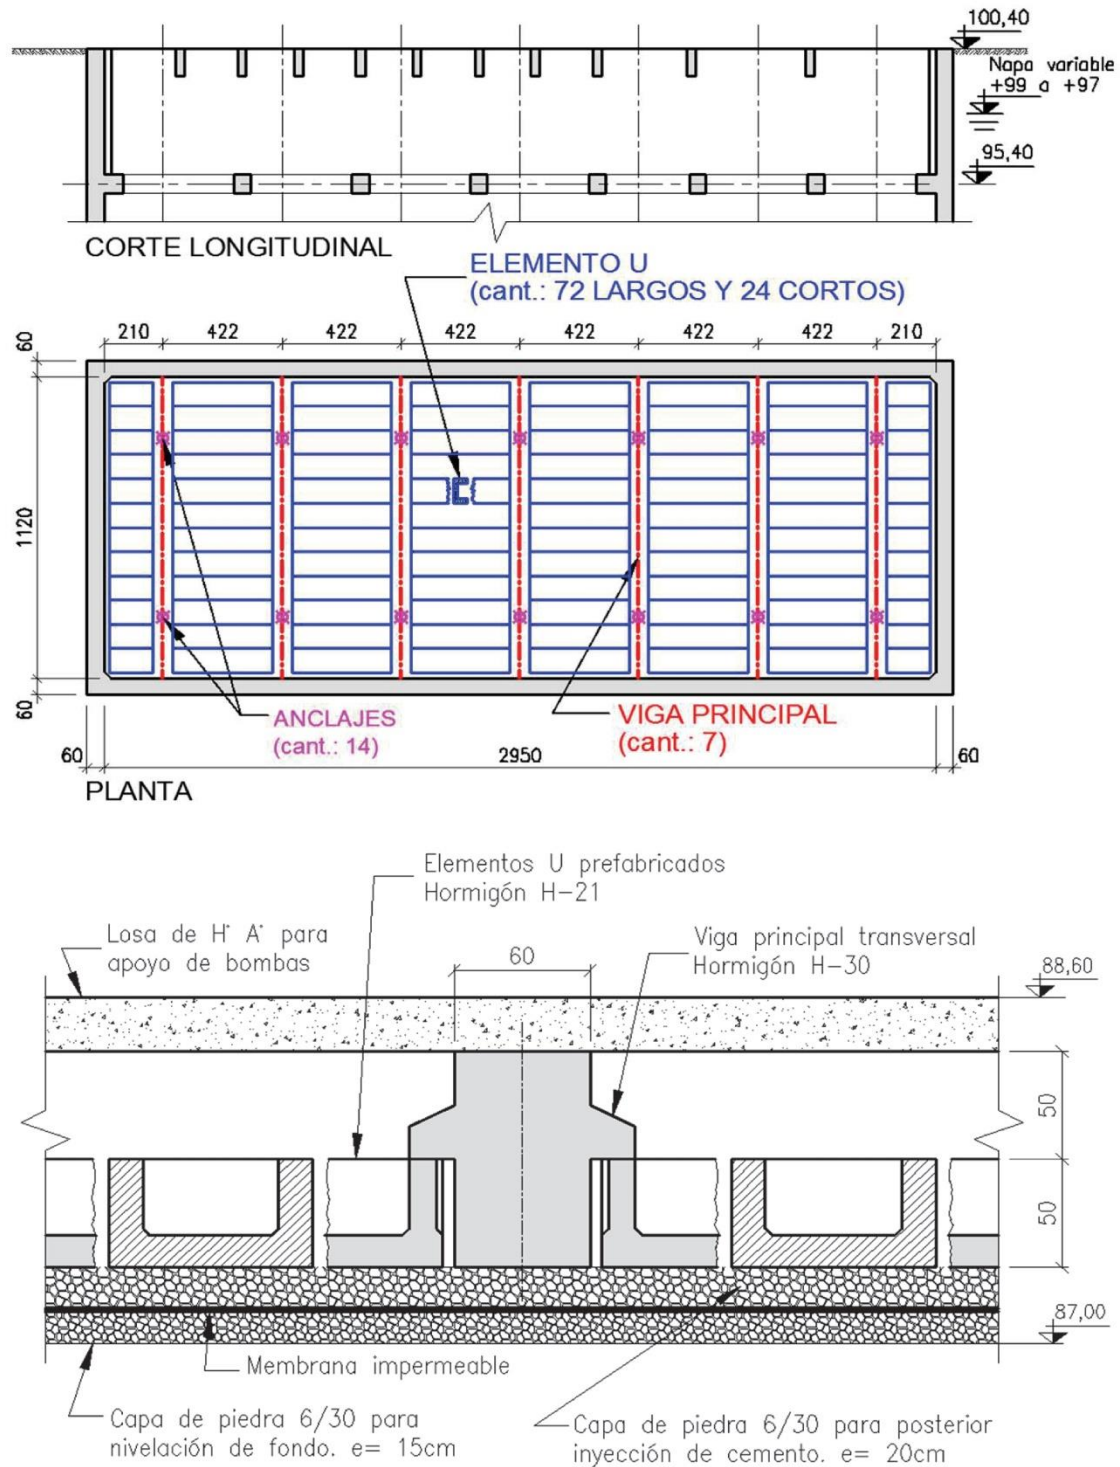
Propuesta N° 4: Vigas secundarias de hormigón armado de sección "U"
